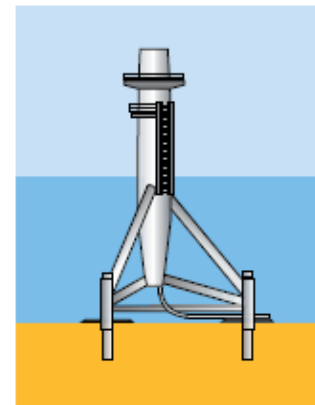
Cimentación tipo trípode. Fuente: EWEA
